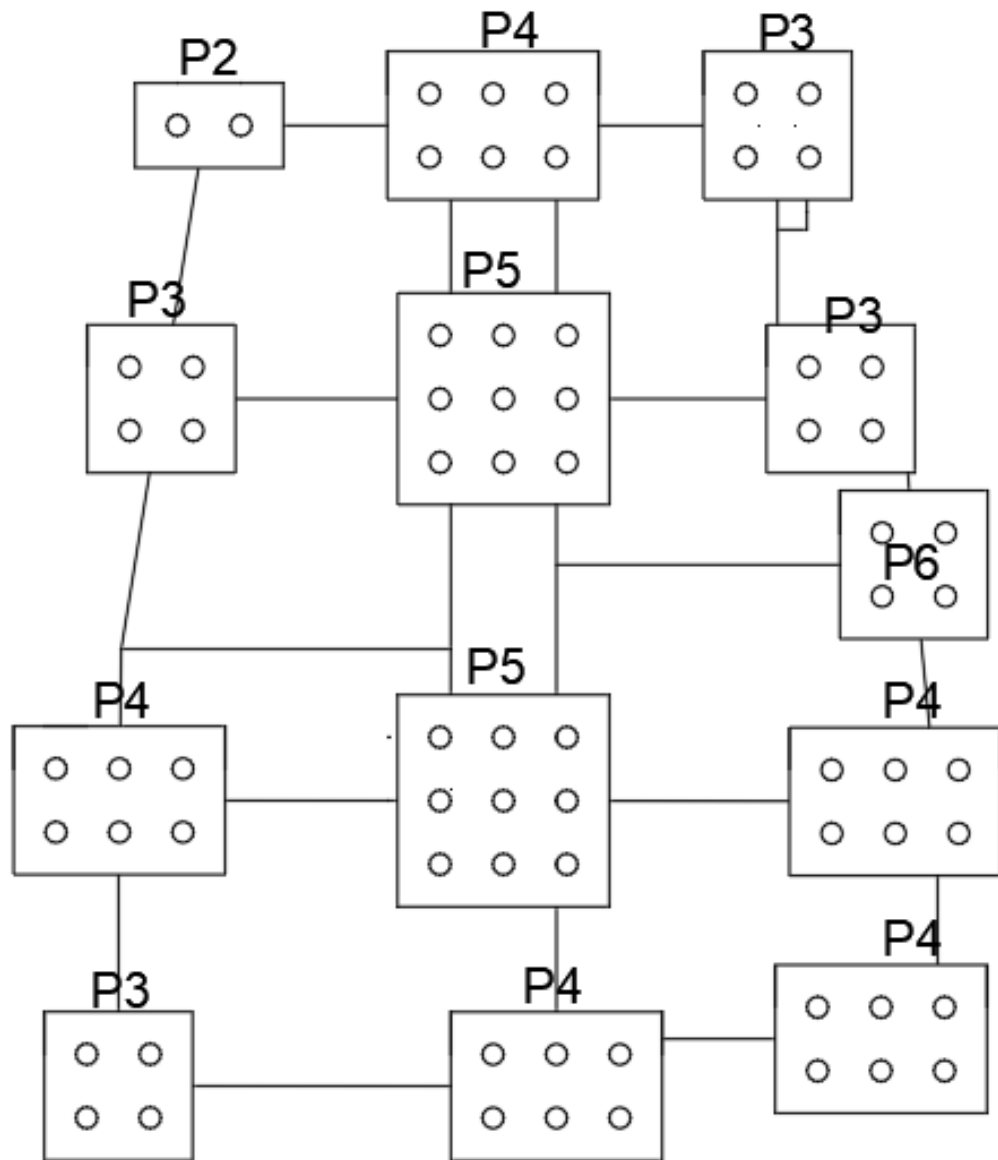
Denah *Final* Pondasi Bangunan A
